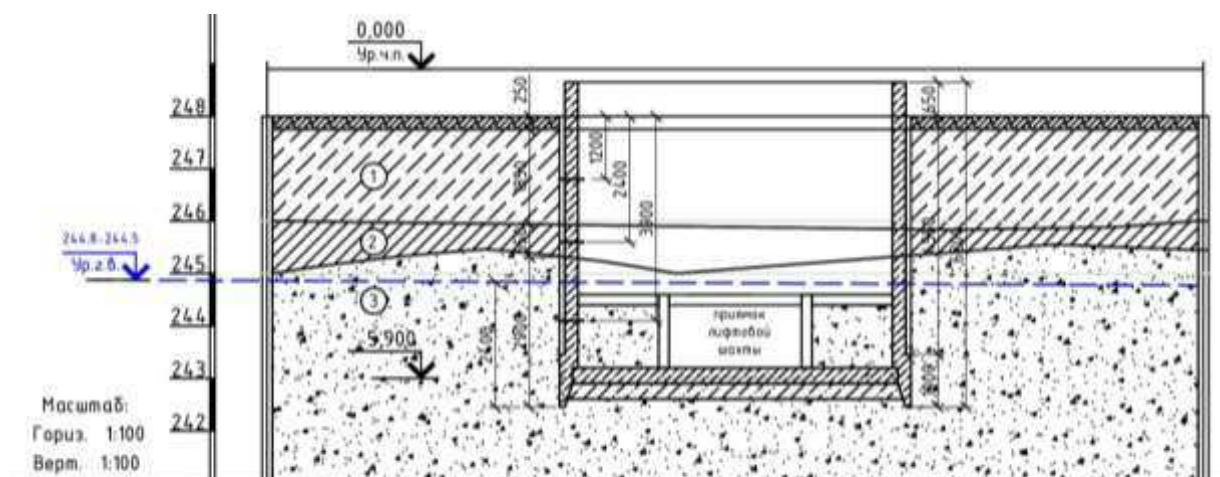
Схема опускного колодца на геологическом разрезе
